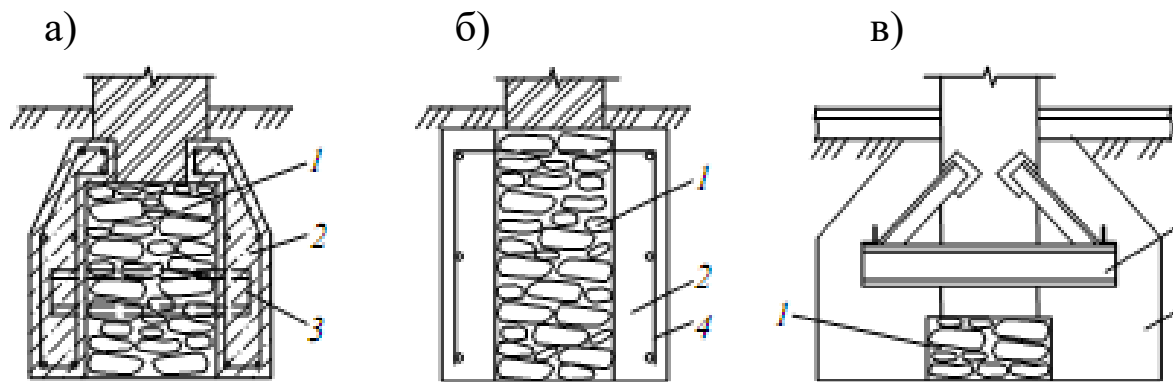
Варіанти посилення бутових і бутобетонних фундаментів:
